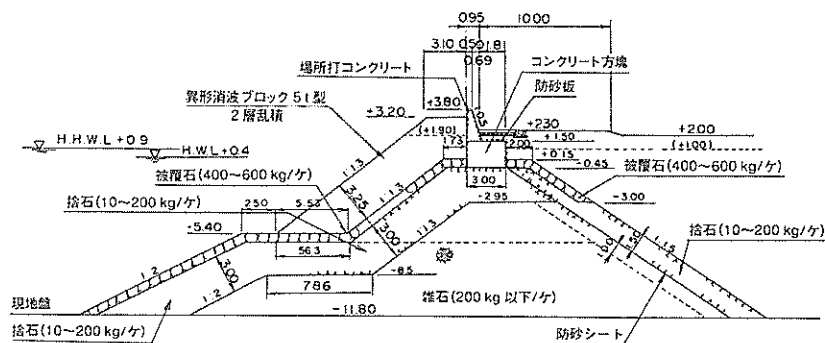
廃棄物外周護岸⑩ 標準断面図
